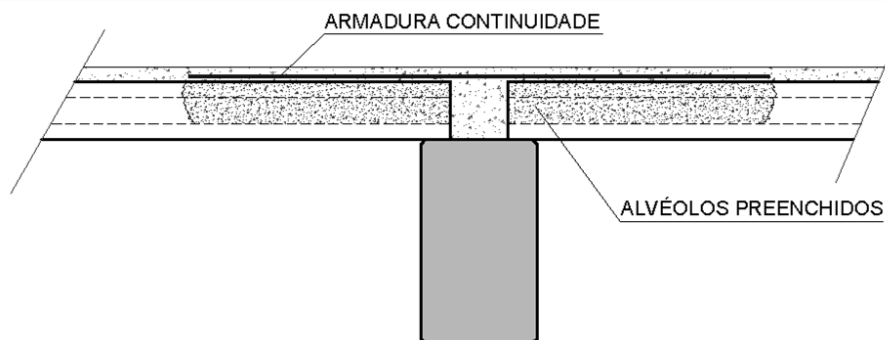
Detalhe da armadura de continuidade entre dois tramos de lajes alveolares (vista lateral).
